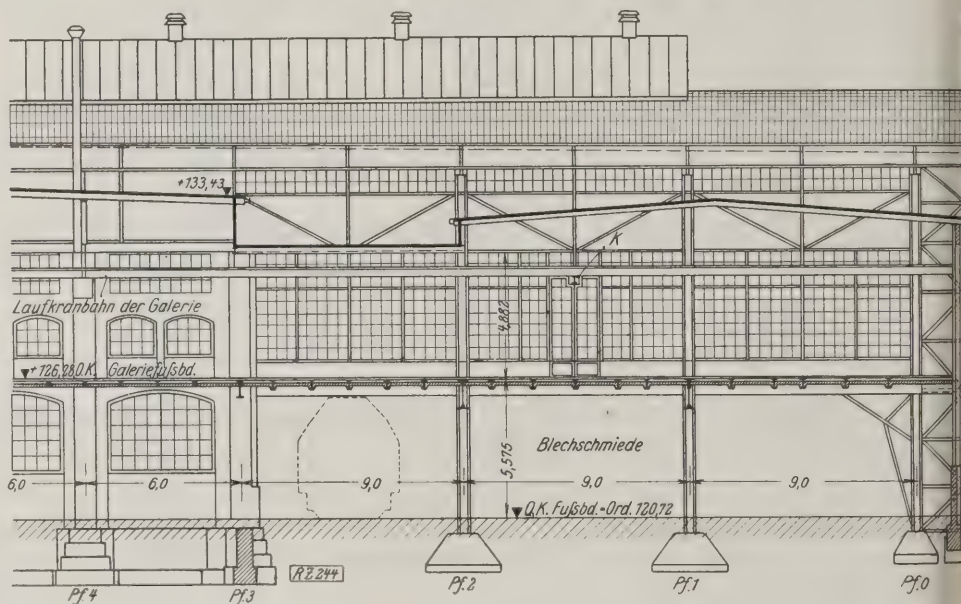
Längsschnitt durch die erhöhte Galerie und neugebaute Blechschmiede mit Seitenansicht der Hallen.
